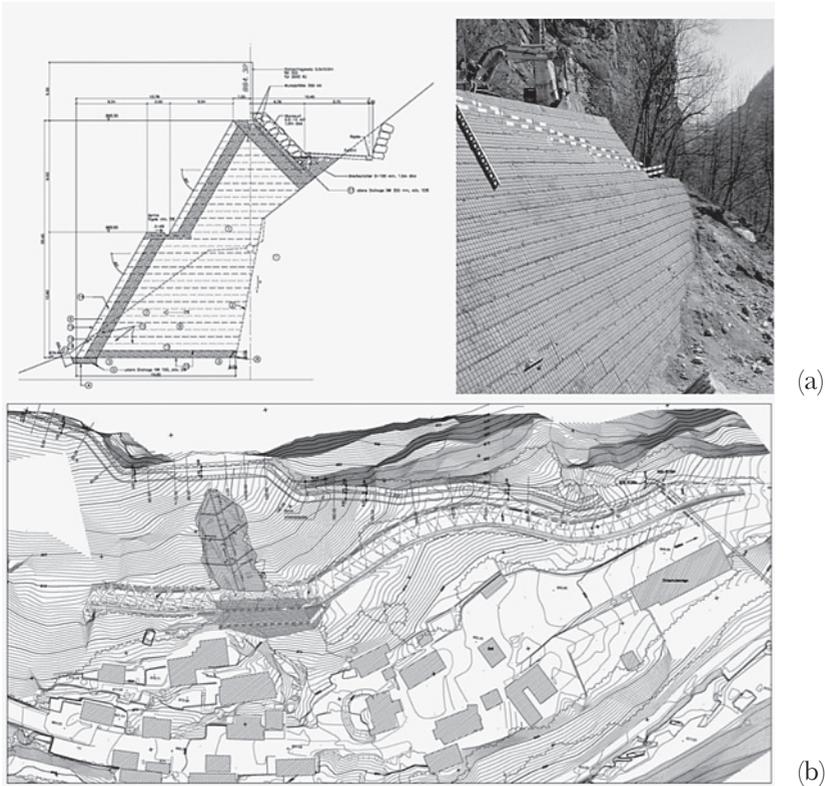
Projet de sécurisation au pied de la falaise: (a) coupe et image de la construction de la digue en terre armée; (b): plan général présentant les interventions techniques (source : A. Squaratti, bureau KBM ingénieurs civils).
